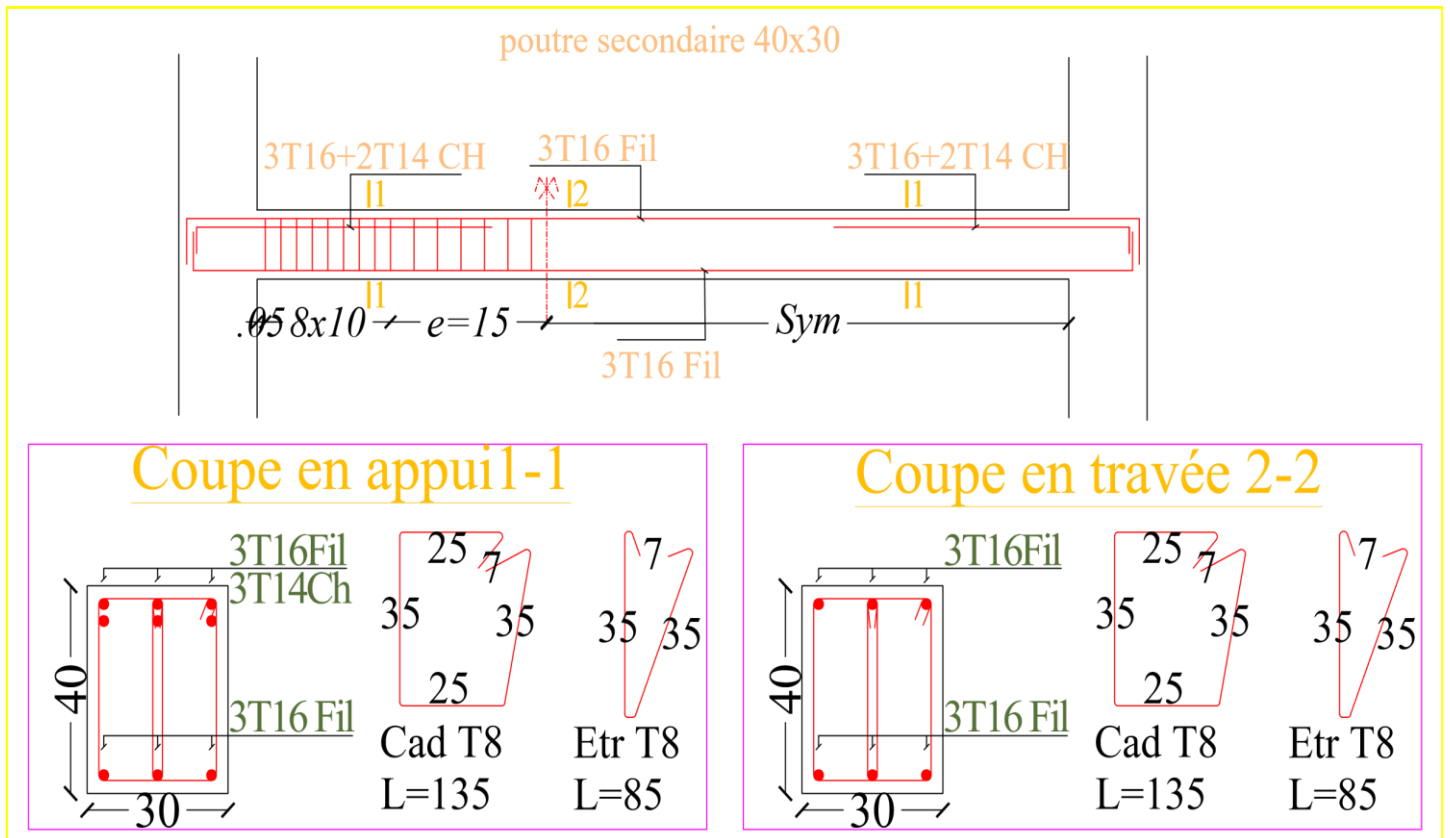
Schéma de ferrailage de poutre secondaire 40x30
